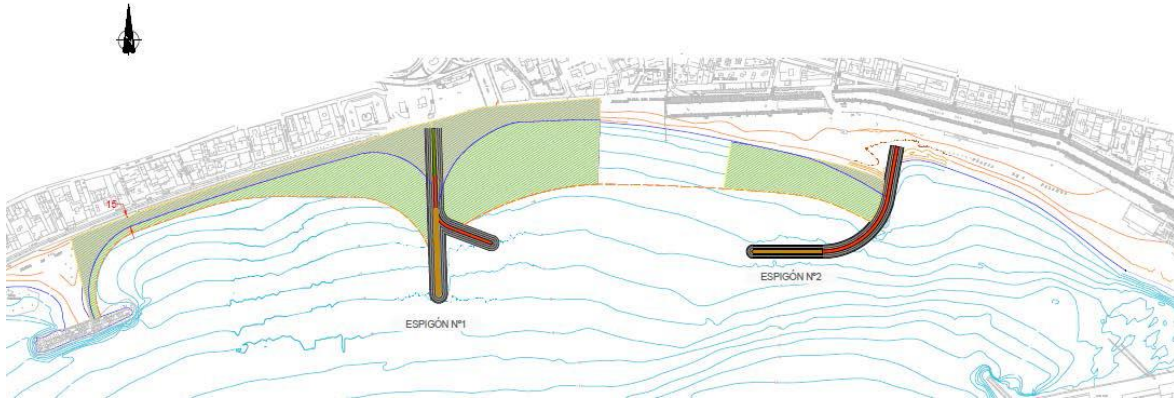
Propuesta en planta del proyecto de estabilización de la Playa de Sant Antoni
